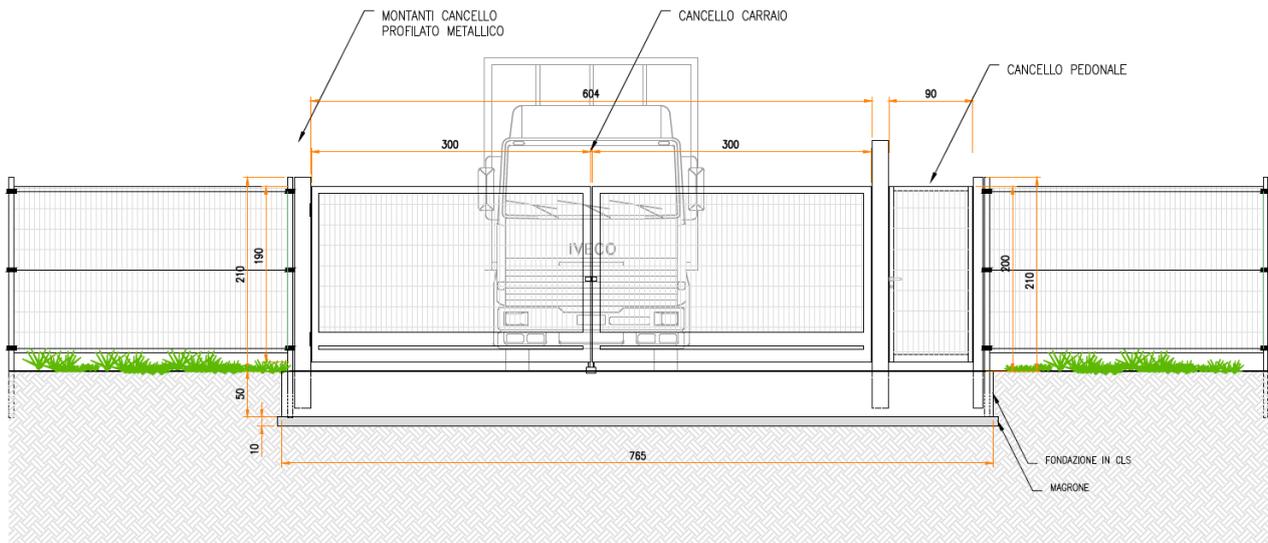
Sezione longitudinale accesso carraio e pedonale
